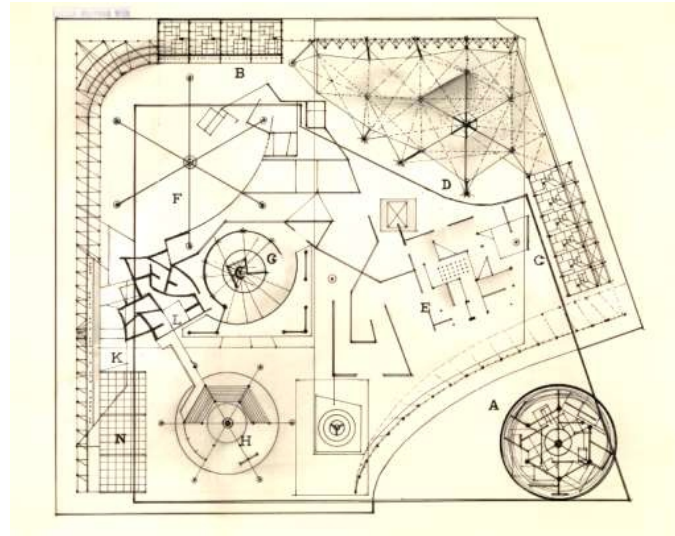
Constant. Planta general del Sector Amarillo.(Gele Sector).1959
